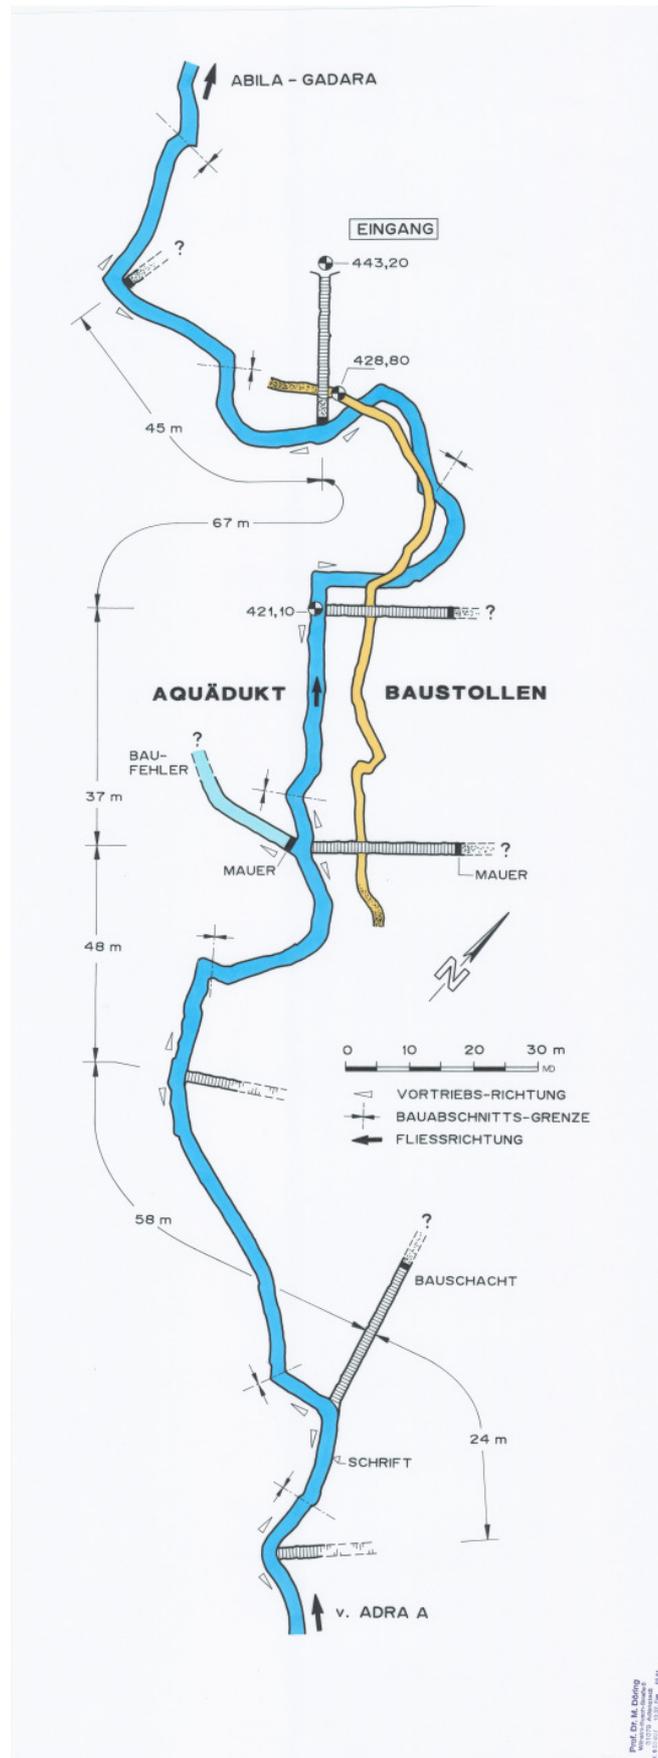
Grundriss eines Tunnelabschnitts östlich von Abila.
